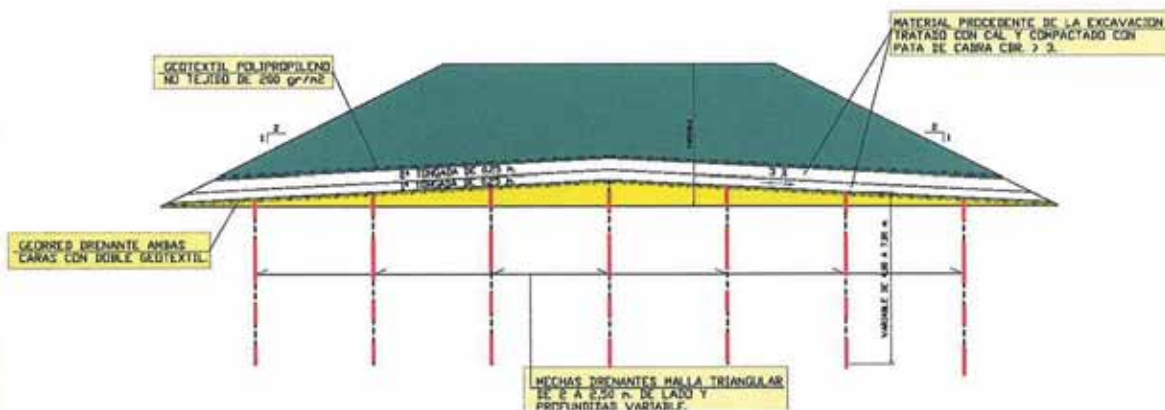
Sección tipo terraplén en zonas tratadas con mezclas drenantes.
